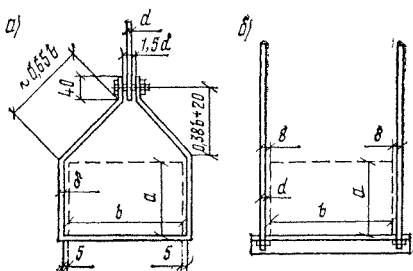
Хомуты а и траверсы б для подвески воздухопроводов прямоугольного сечения
